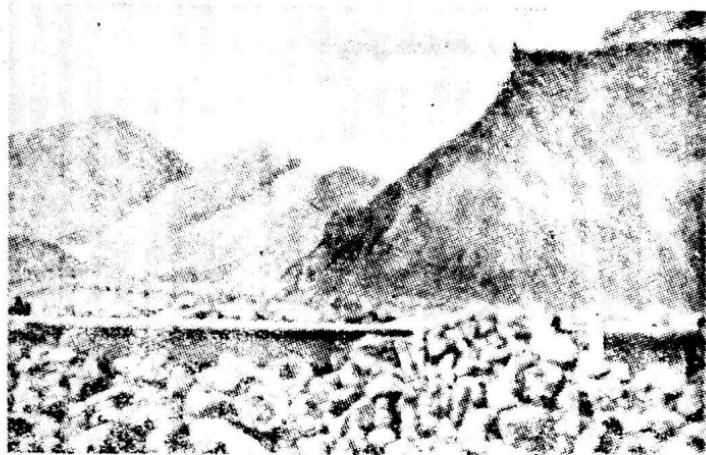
被巨大的块石堵塞的钢筋混凝土梁式桥
